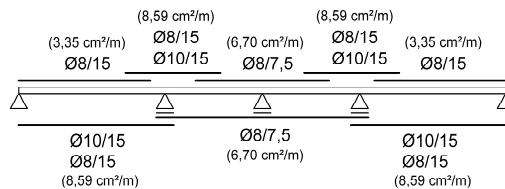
Bewehrungsskizze der erforderlichen Bewehrung zur Begrenzung der Rissbreite bei Überlagerung der Beanspruchungen infolge von Zwang und äußerer Last
